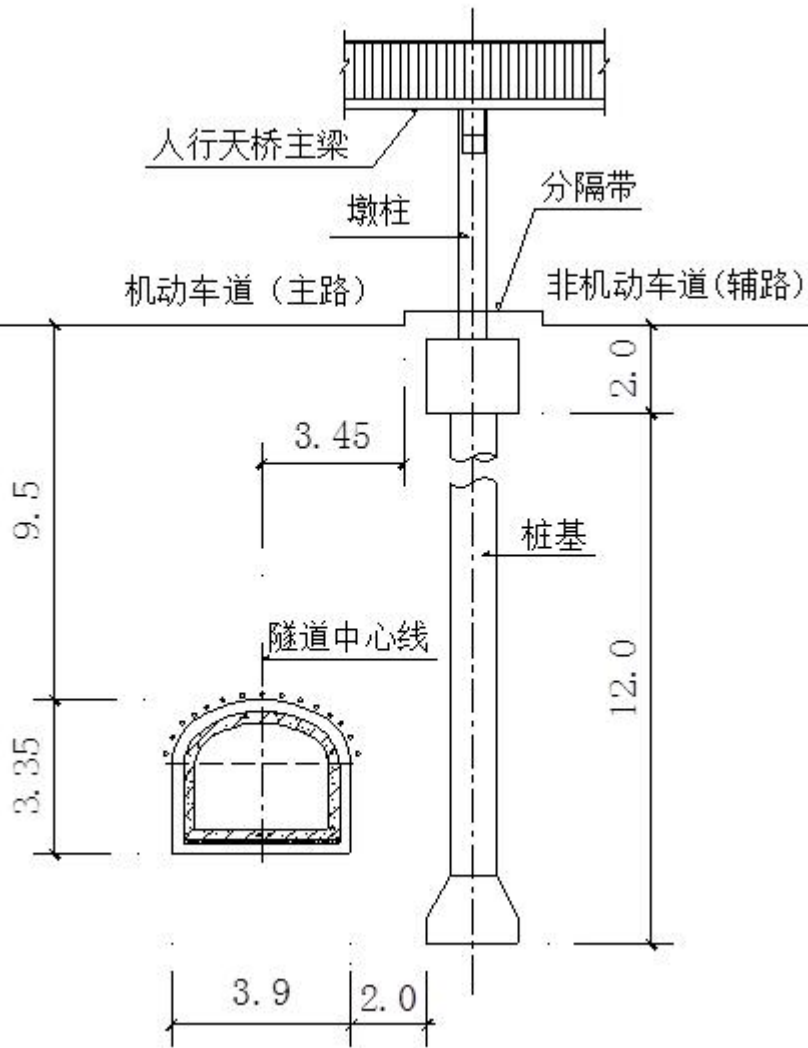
下穿人行天桥隧道横断面示意图 (单位: m)
